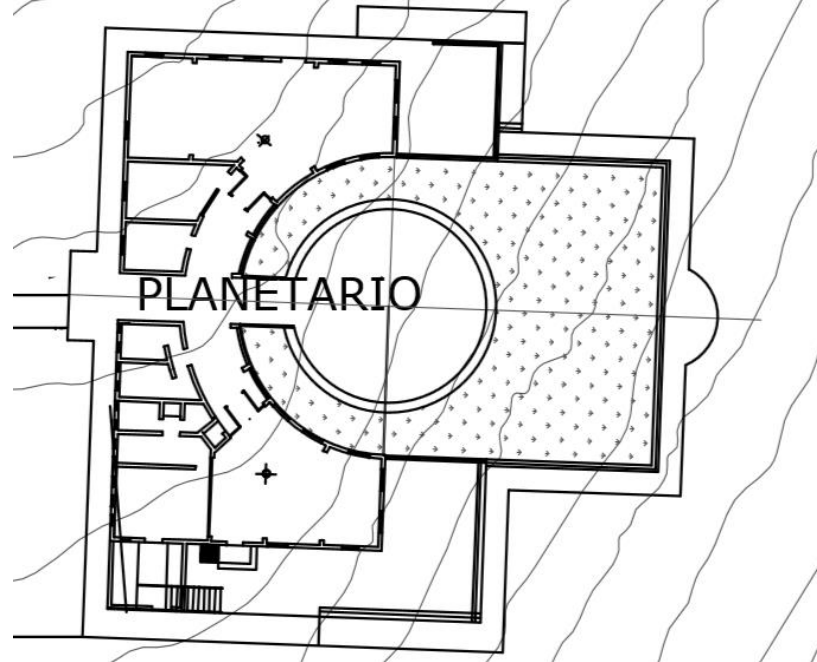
Primer plano del observatorio Cerro Mamalluca.
